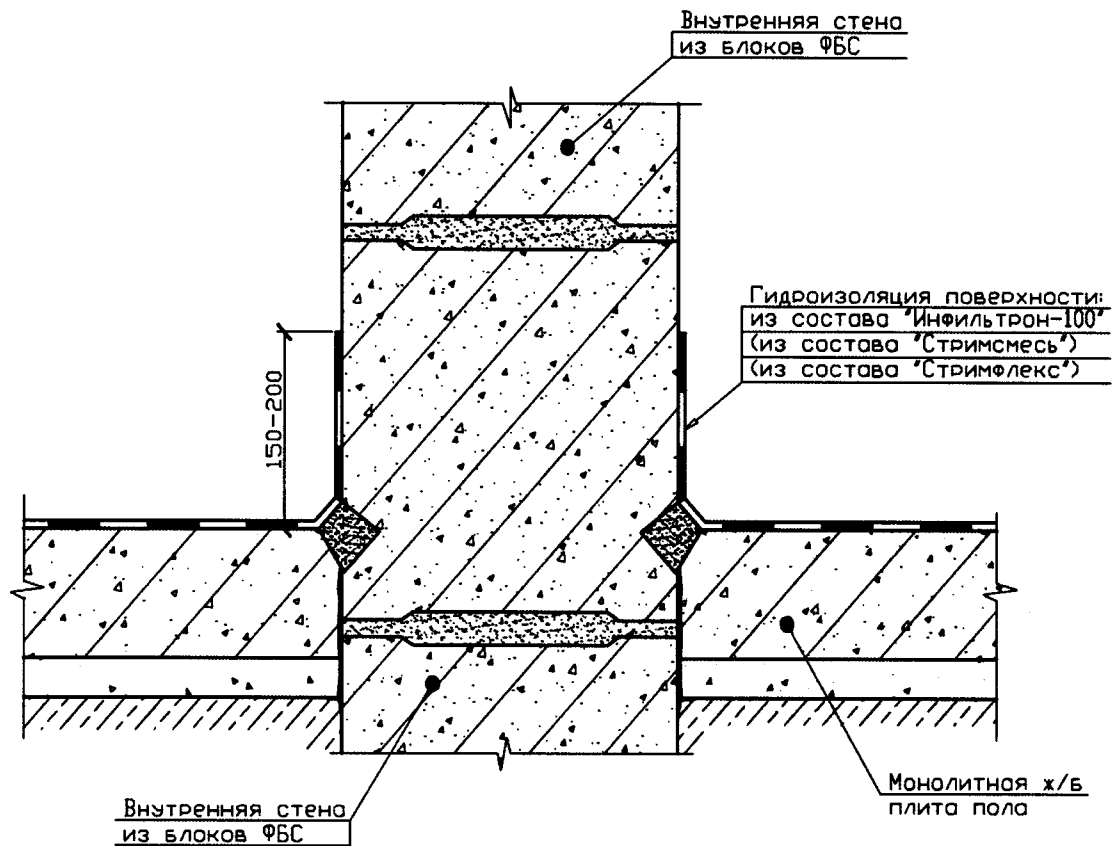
Гидроизоляция поверхностей сборных железобетонных конструкций. Гидроизоляция поверхностей внутренних стен из блоков ФБС и плиты пола
